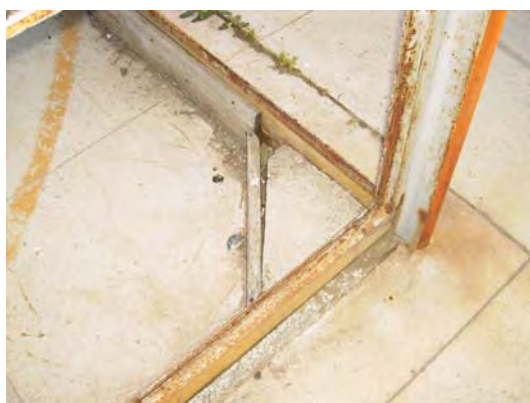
Detalle del vallado perimetral de la pista de juego en la parte inferior de la esquina noroeste.
